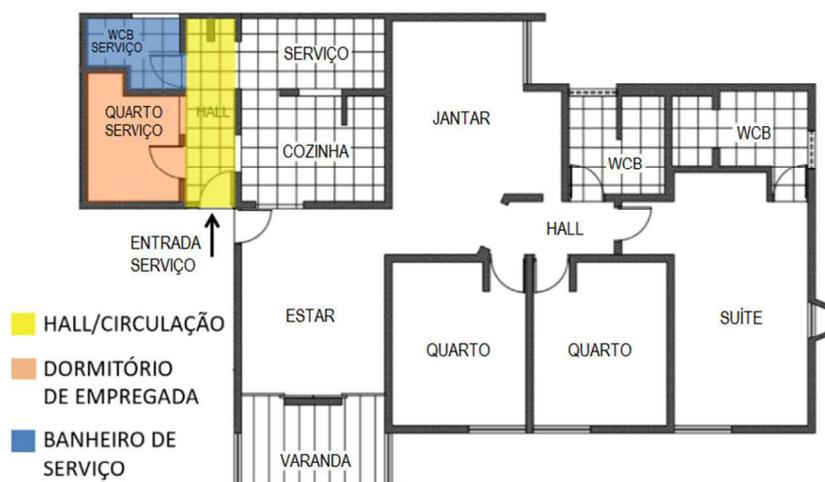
Planta baixa de unidade do Edifício Dom Avelar (1977)
